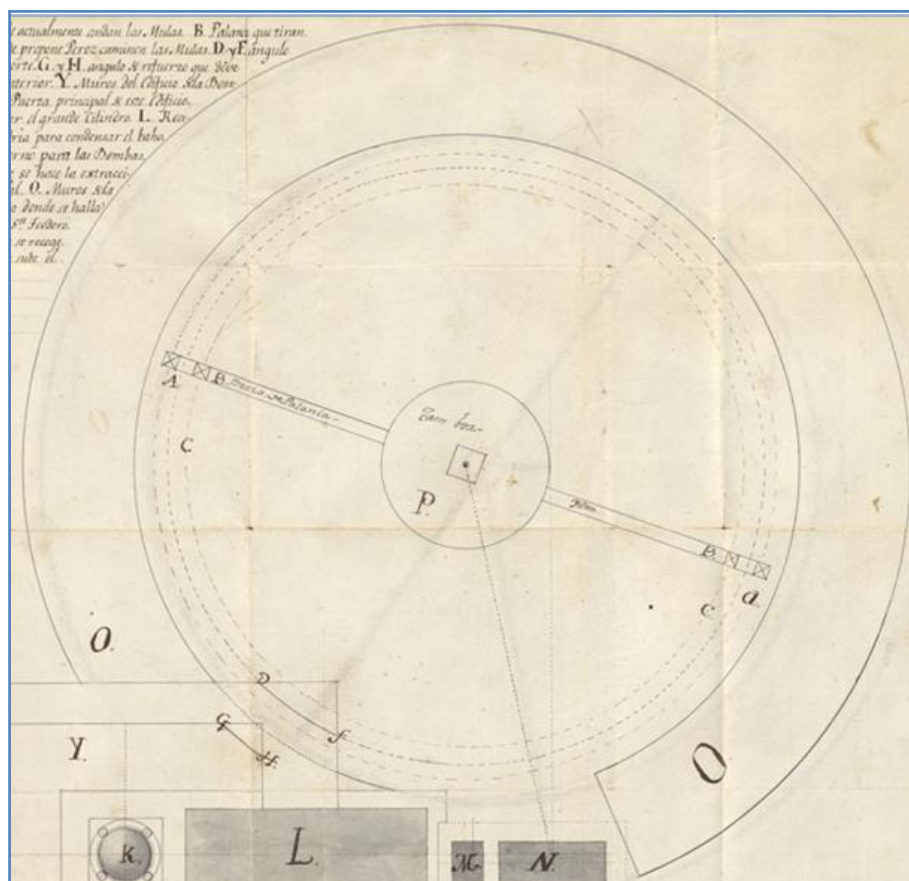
Detalle de la sección en planta del baritel. Plano FCMA-1488
